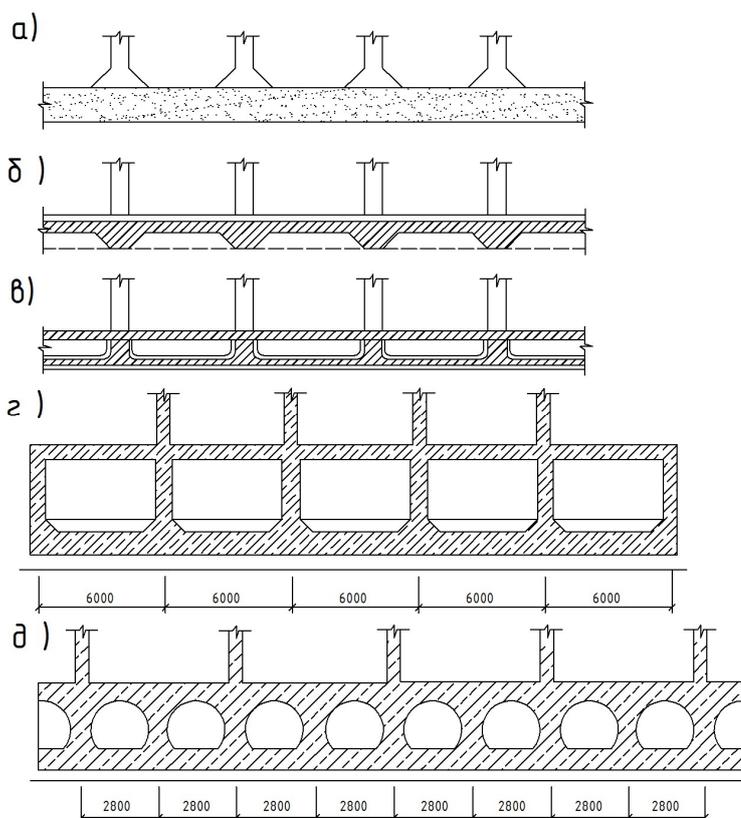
Сплошные фундаментные плиты: а – без ребер; б – ребрами вниз; с ребрами вверх; г – коробчатые; д – объемный фундамент
